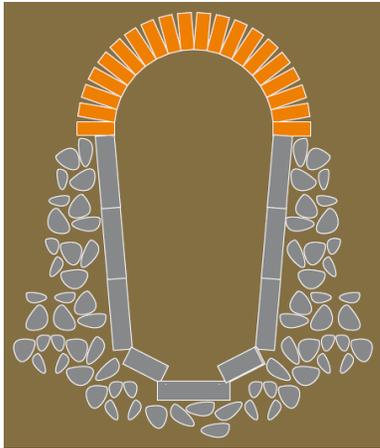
Perfil: Colector abovedado, de ladrillo y piedra trabajada.
